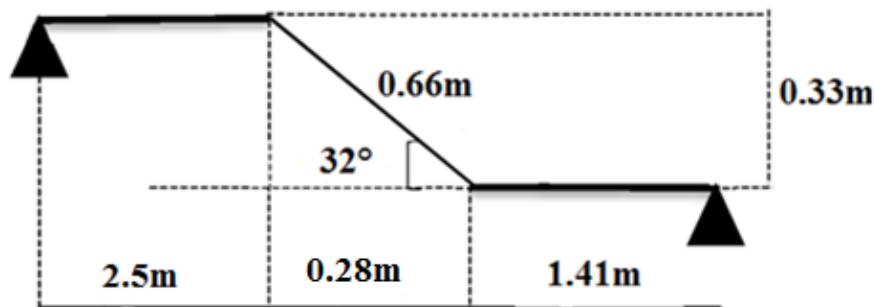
Schéma statique de la poutre palière de l'escalier
